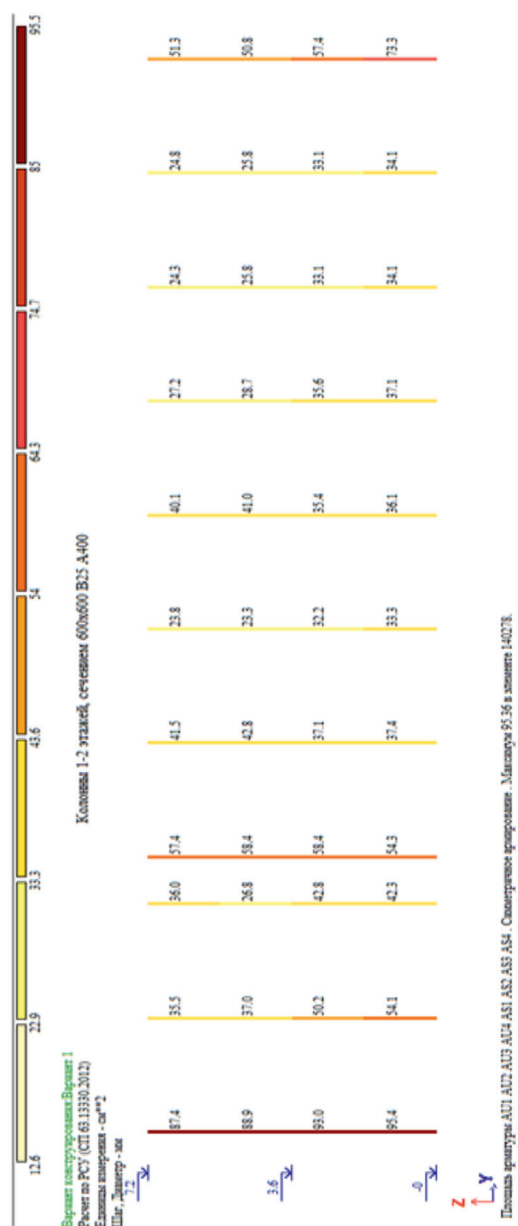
Армирование колонн 1 и 2 этажей по осям 6, 7. Сечение 600х600, бетон В25
